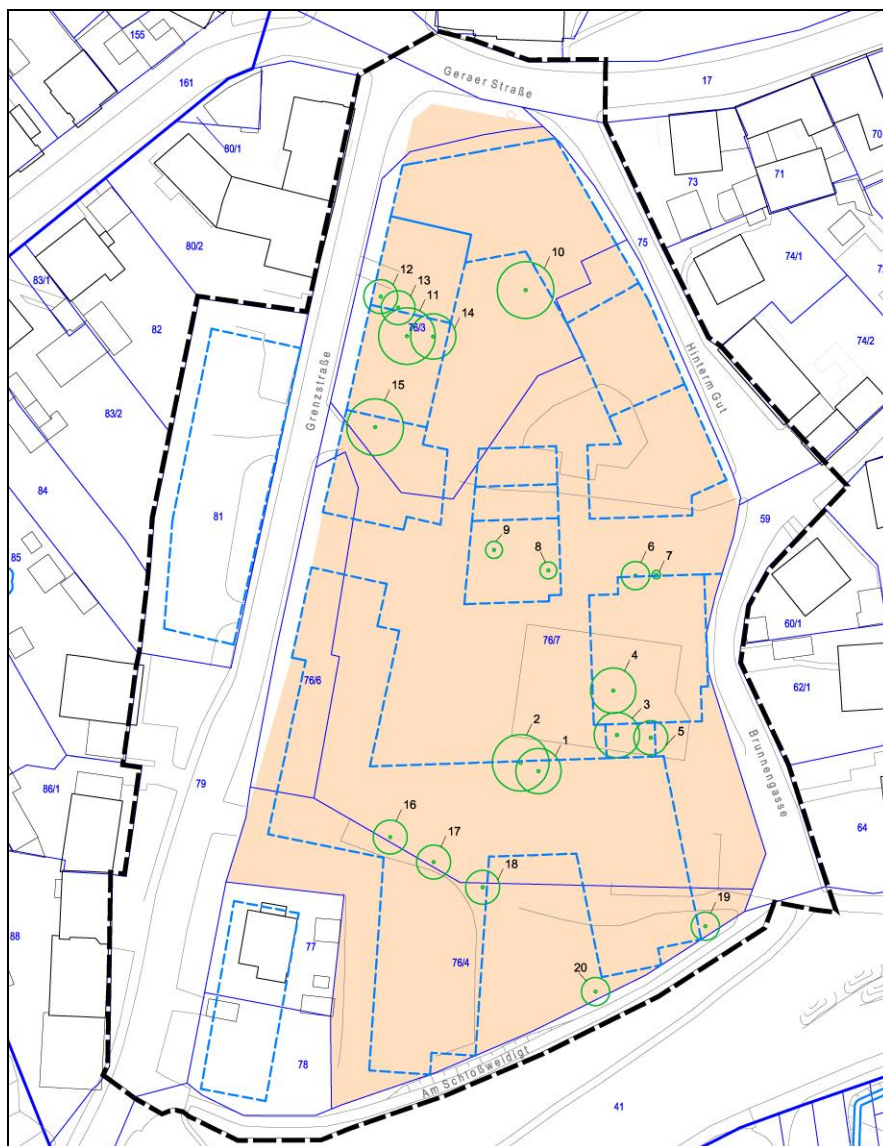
Lageplan zum Baumbestand nach Baumschutzsatzung im Bereich WA₁ und WA₂ (Quelle: quaas-stadtplaner)
